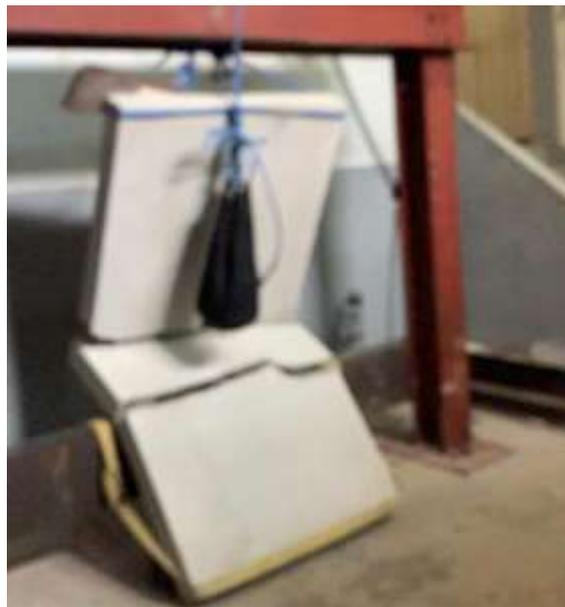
Momento del impacto al espécimen con bloques de hormigón.
